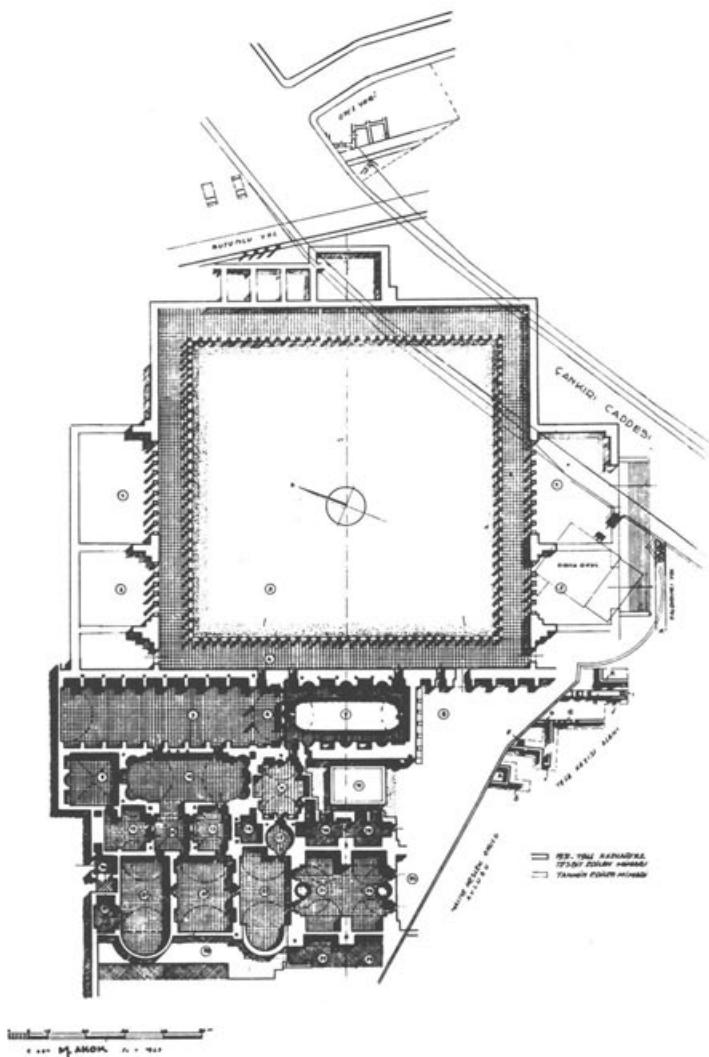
Ankara, Grundriss der Thermenanlage.
